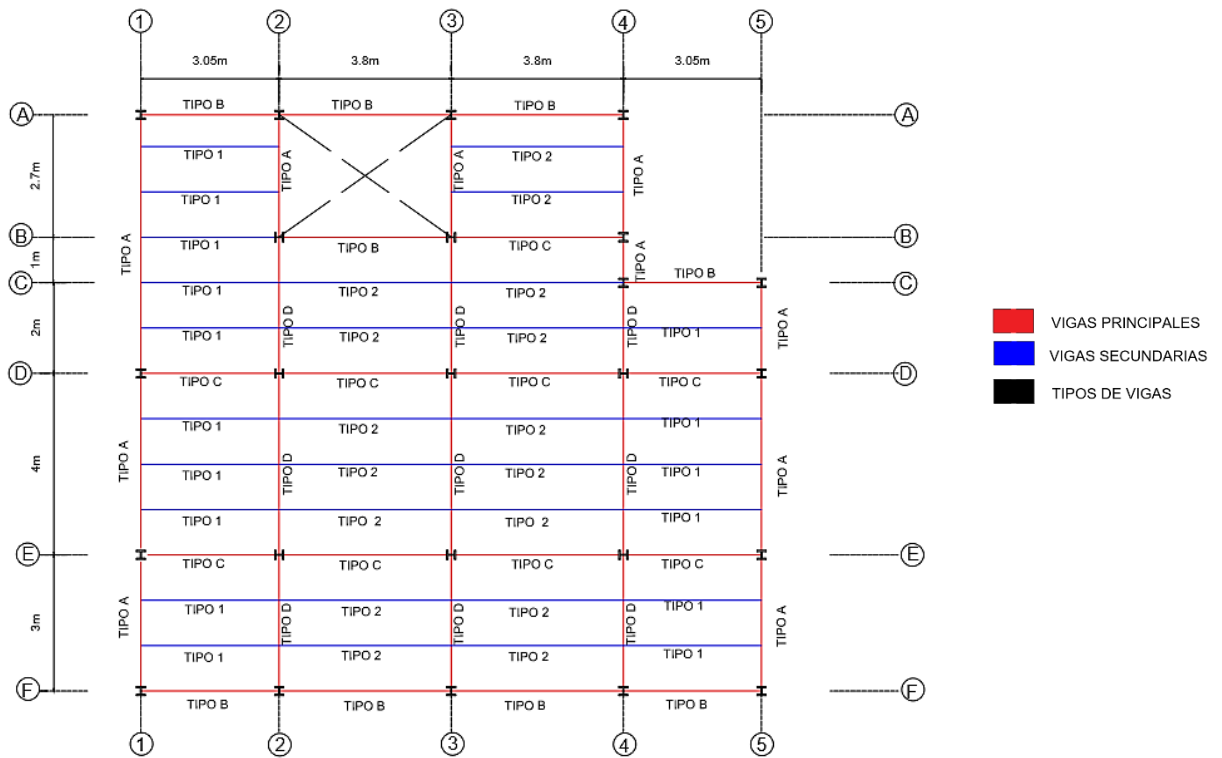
Planta con sus respectivas vigas principales y secundarias
